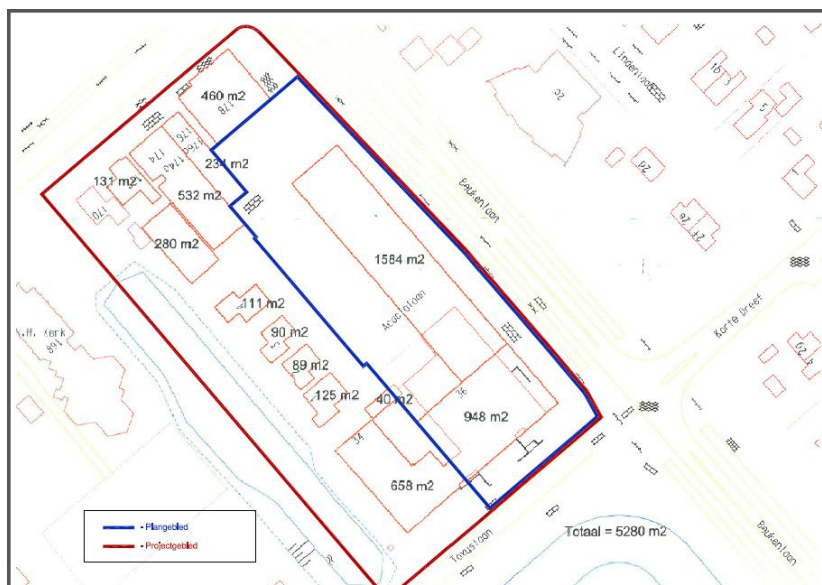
aanwezige en geprojecteerde bebouwing op de locatie Acacialaan, en ligging van het project binnen het plangebied
